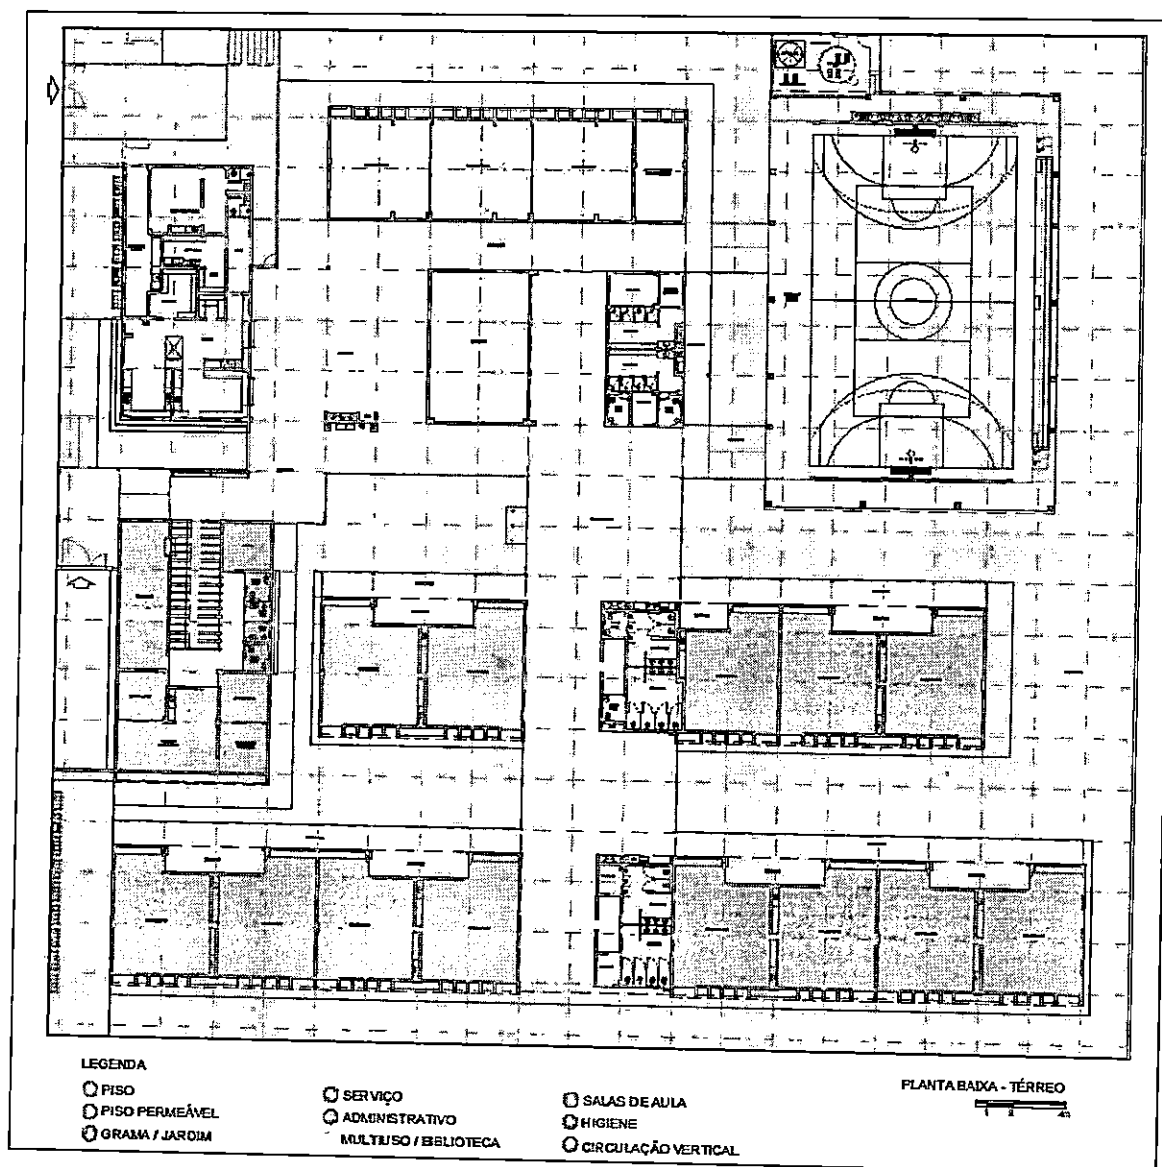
planta baixa de implantação dos blocos – Escola 13 Salas - Térreo
